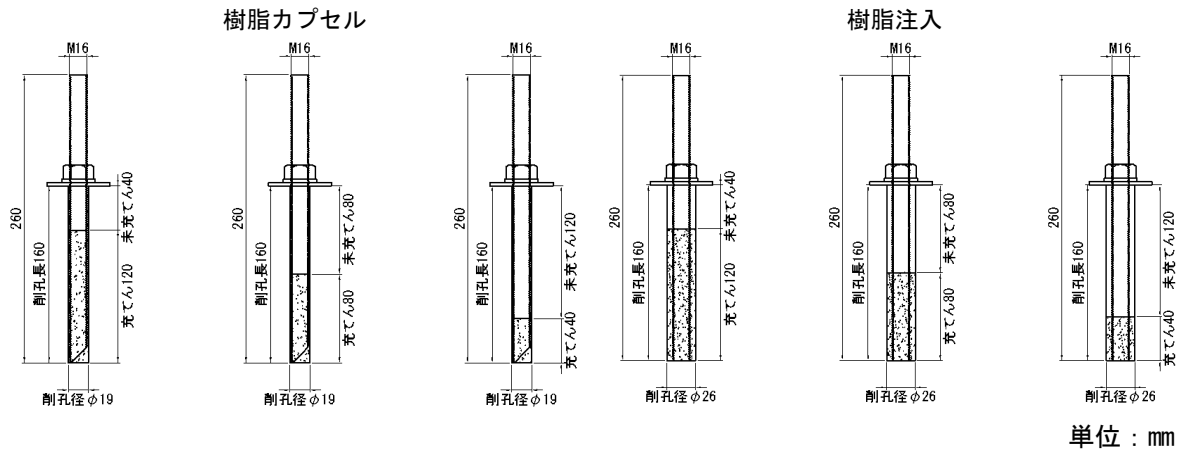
あと施工アンカー施工図（充填不足・M16 下向き）
